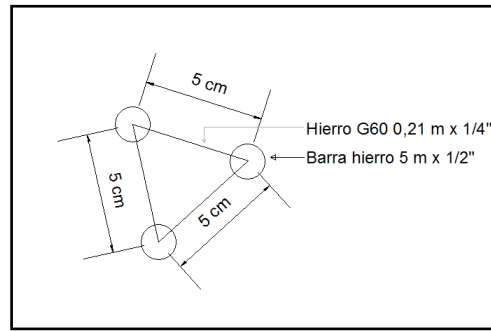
Varilla de refuerzo 5 m (Vista en planta).
